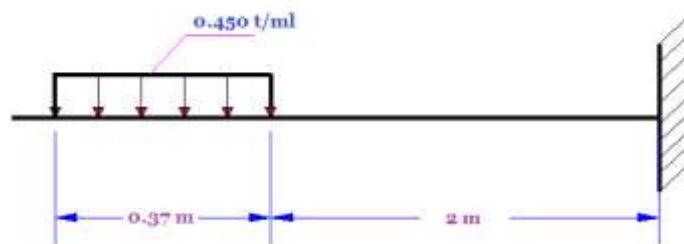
Surcharge de trottoir sur la dalle d'encorbellement
